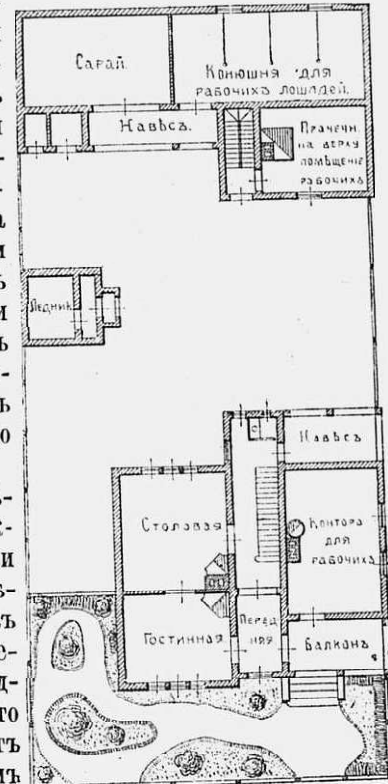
Типъ (планъ) малой усадьбы на 98 кв. сажень. Планъ 1 этажа построекъ.
